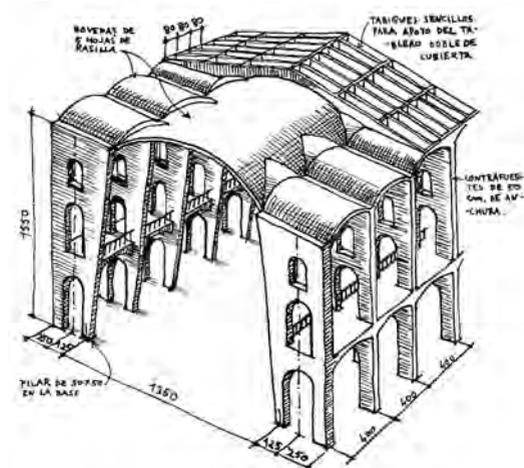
Primer proyecto –no construido- para la parroquia de San Agustín («Nave cubierta de bóveda cilíndrica con lunetos, contrarrestada con cañones perpendiculares, apoyados sobre contrafuertes aligerados») (ca. 1941) [en Moya 1947, 43].
